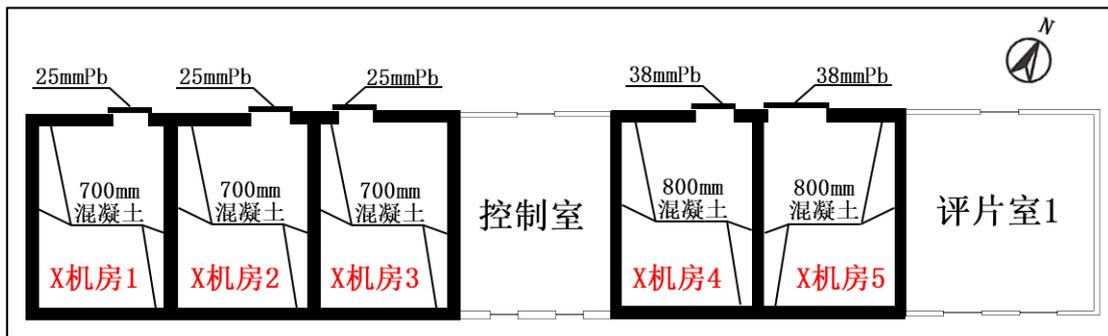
X 机房 1~5 屏蔽设计示意图-平面图
